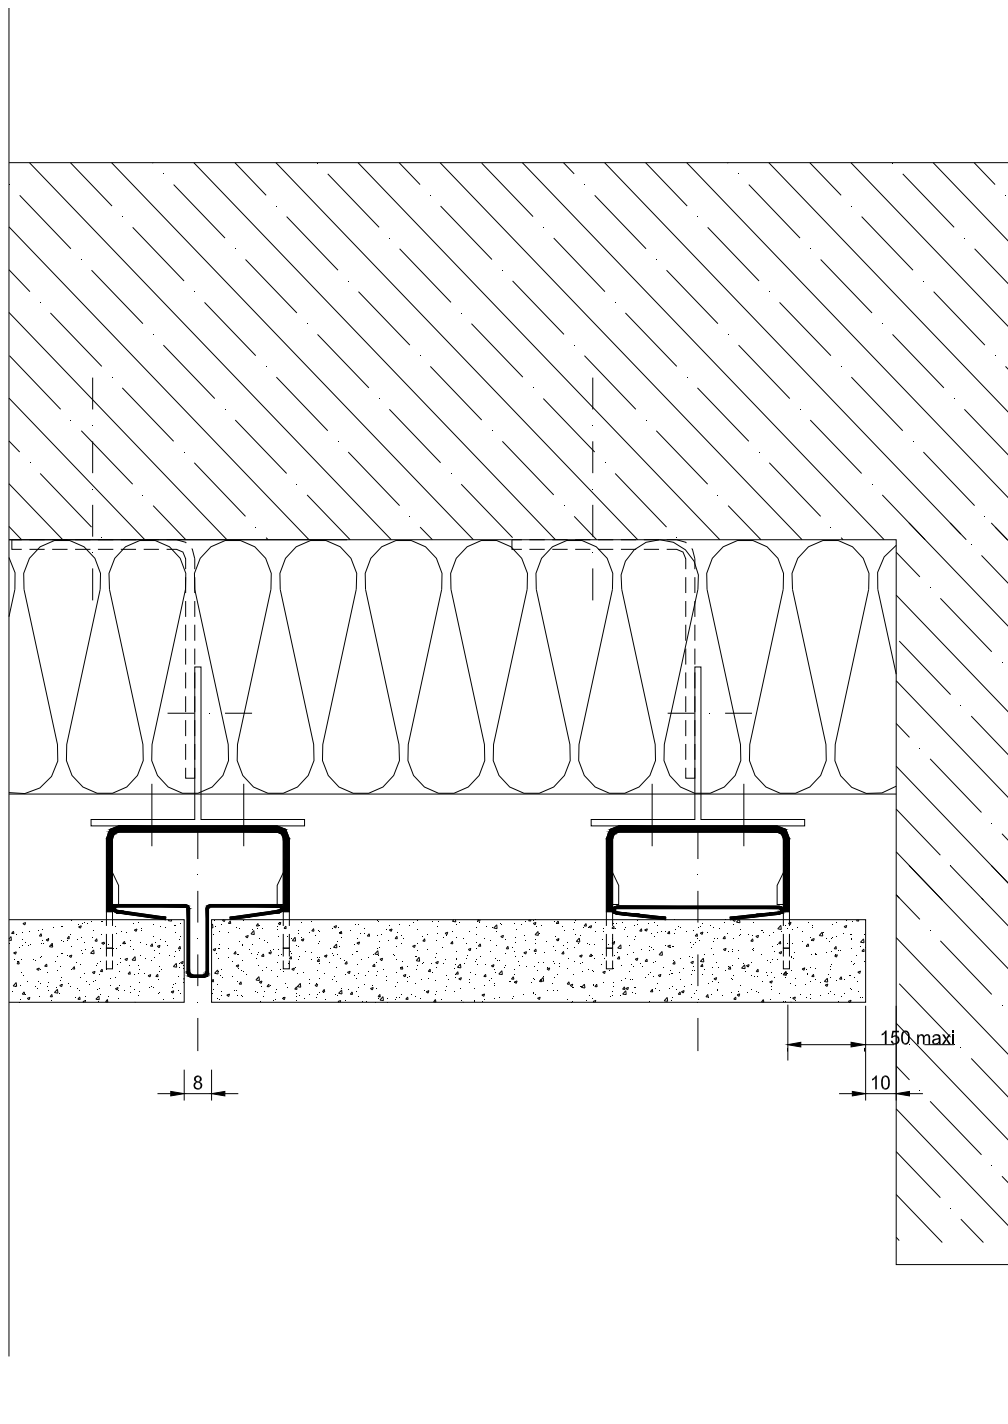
Principe de pose en sous-face - coupe transversale – Ossature Aluminium
